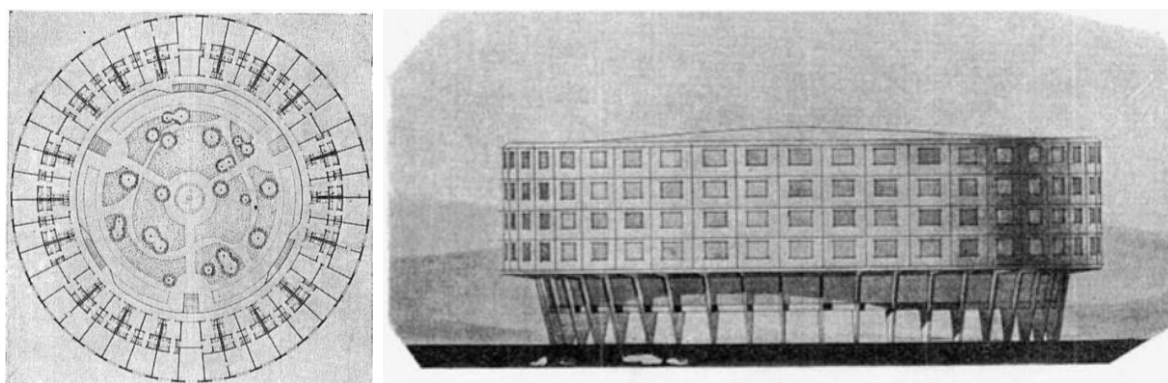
Жилой комплекс для Арктического побережья. План первого этажа и фасад. Источник: <https://arzamas.academy/materials/1821>
